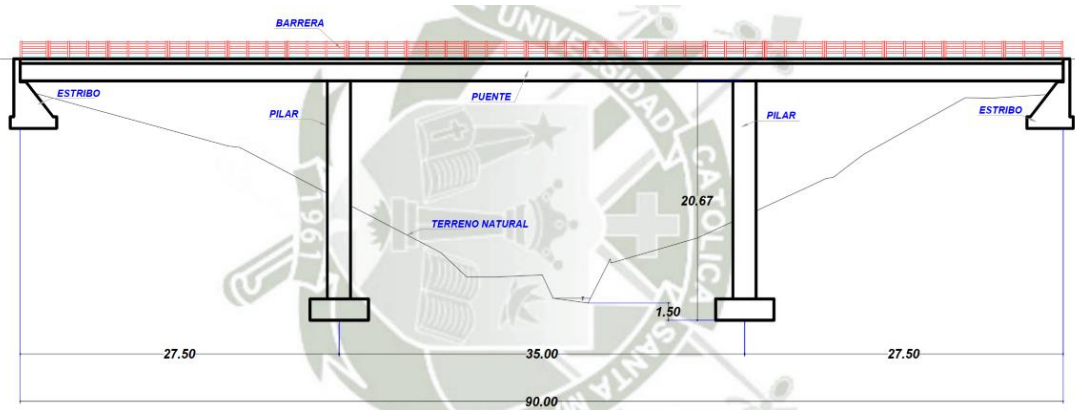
Puente Añashuayco, vinculación longitudinal (Fuente: [28]).
